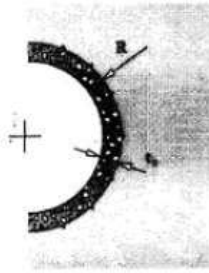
Representação esquemática das seções: anel de concreto ou concreto projetado, (modificado de BRADY e BROWN, 2004).
